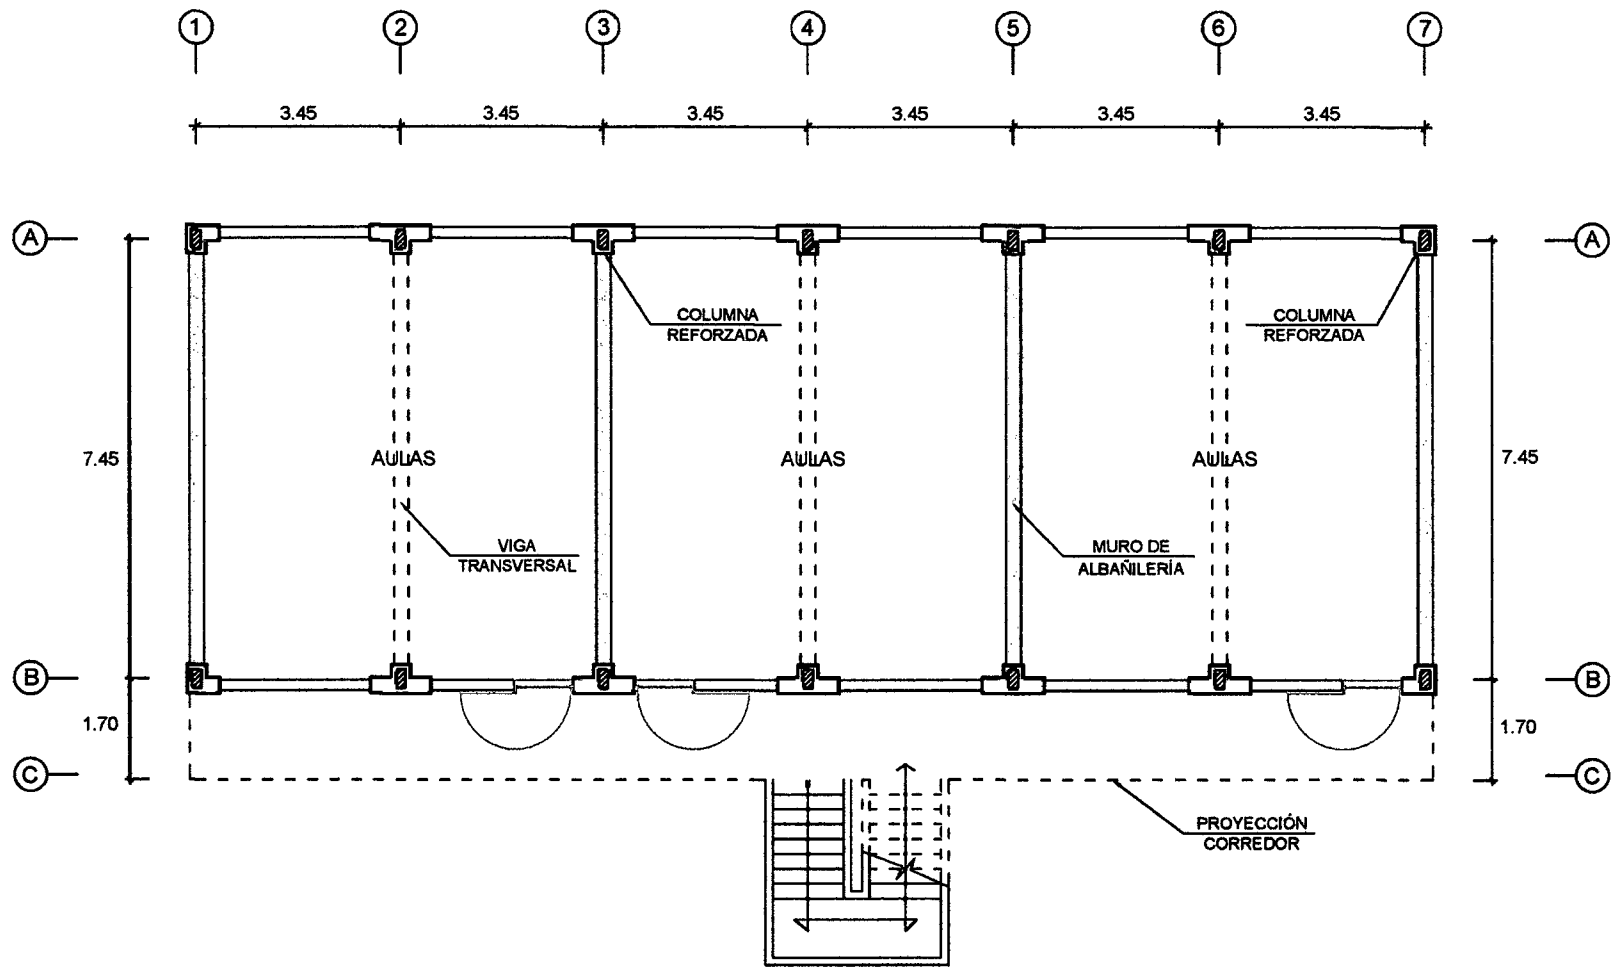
Reforzamiento del pabellón 2 incorporando columnas T y L.
